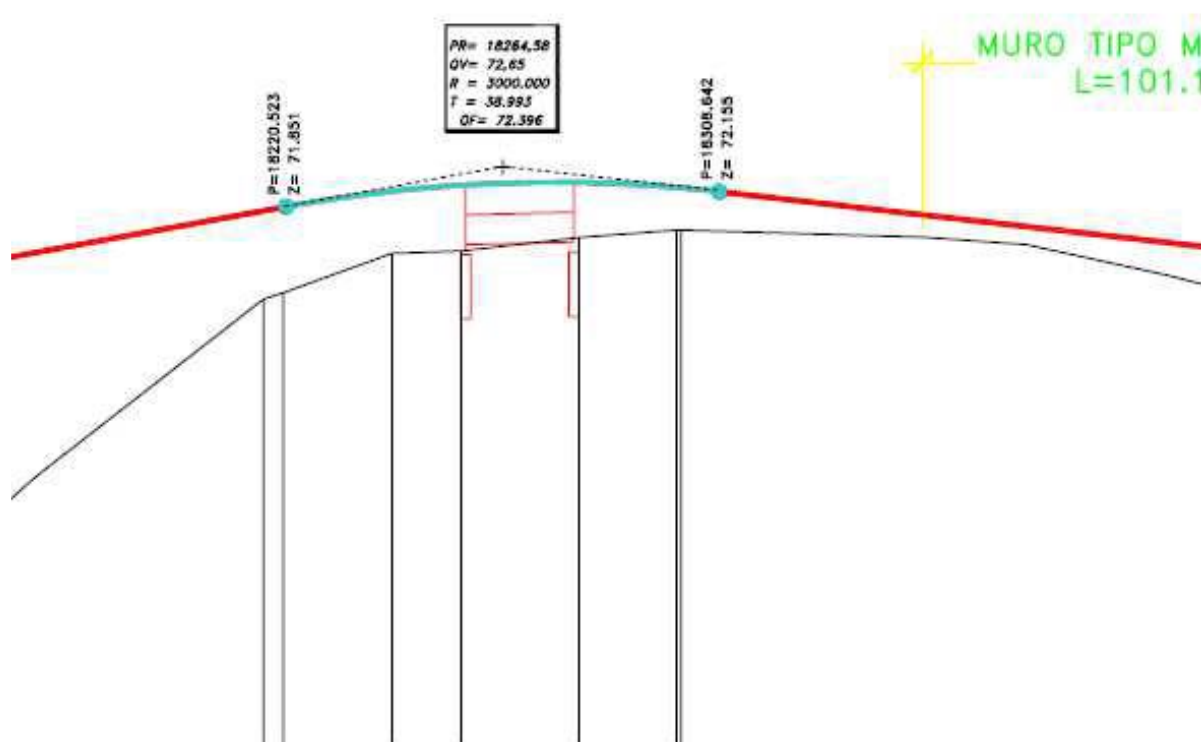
Exemplo de traçado em perfil longitudinal (Fontul, 2024)
